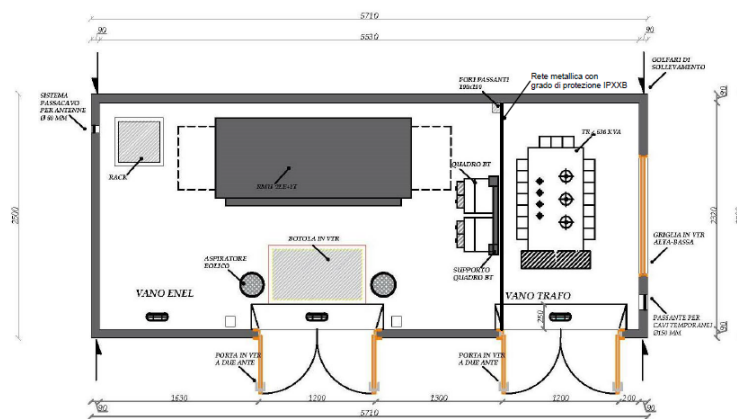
Vista in pianta della cabina di sezionamento modello DG 2061 ed.VIII.
